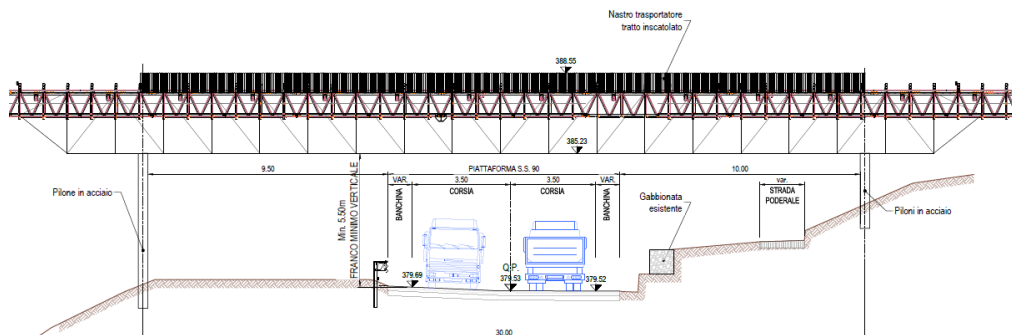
Sezione tipo attraversamento nastro trasportatore su SS90.
